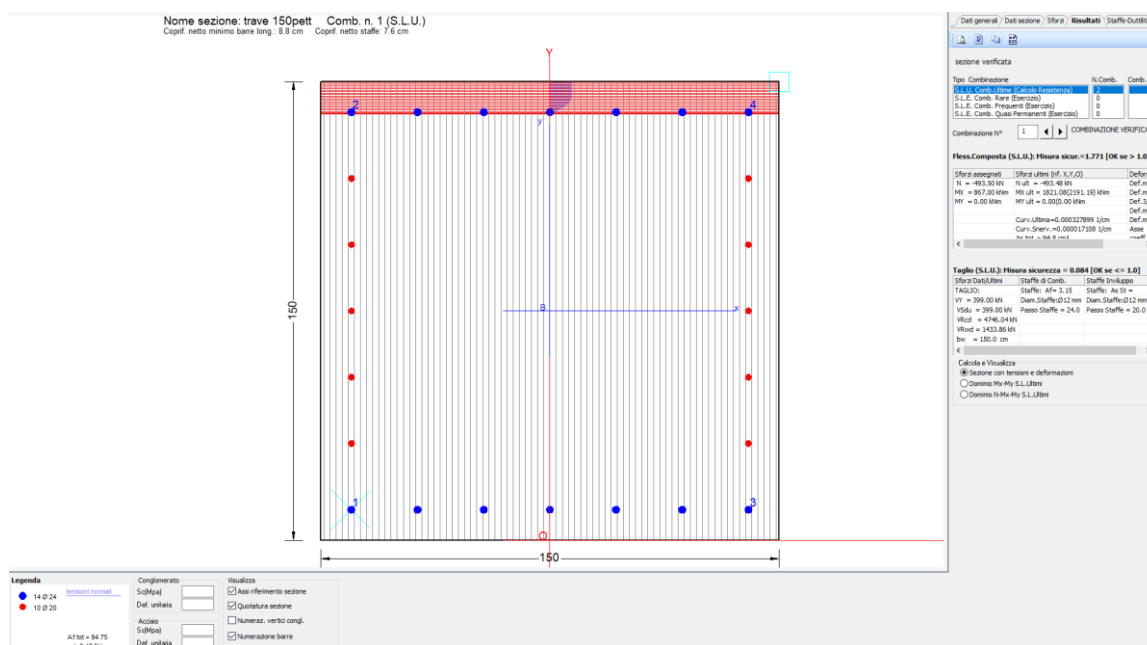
Armatura trave collegamento pali retrostanti (1.5 m x 1.5 m)
